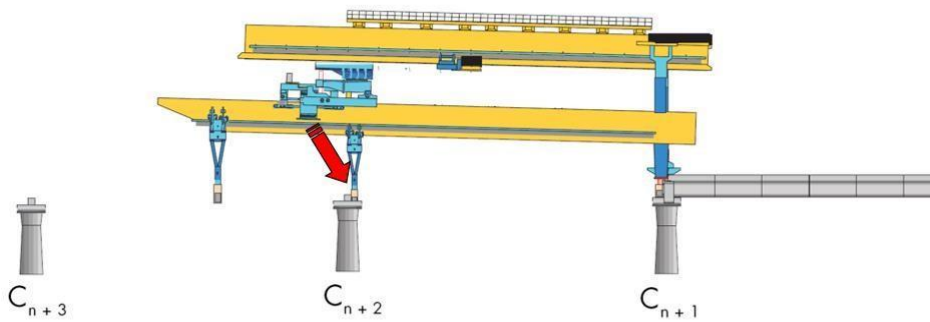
Avance de la viga lanzadora, Fase 2: avance de la viga superior sobre la viga inferior (2)
